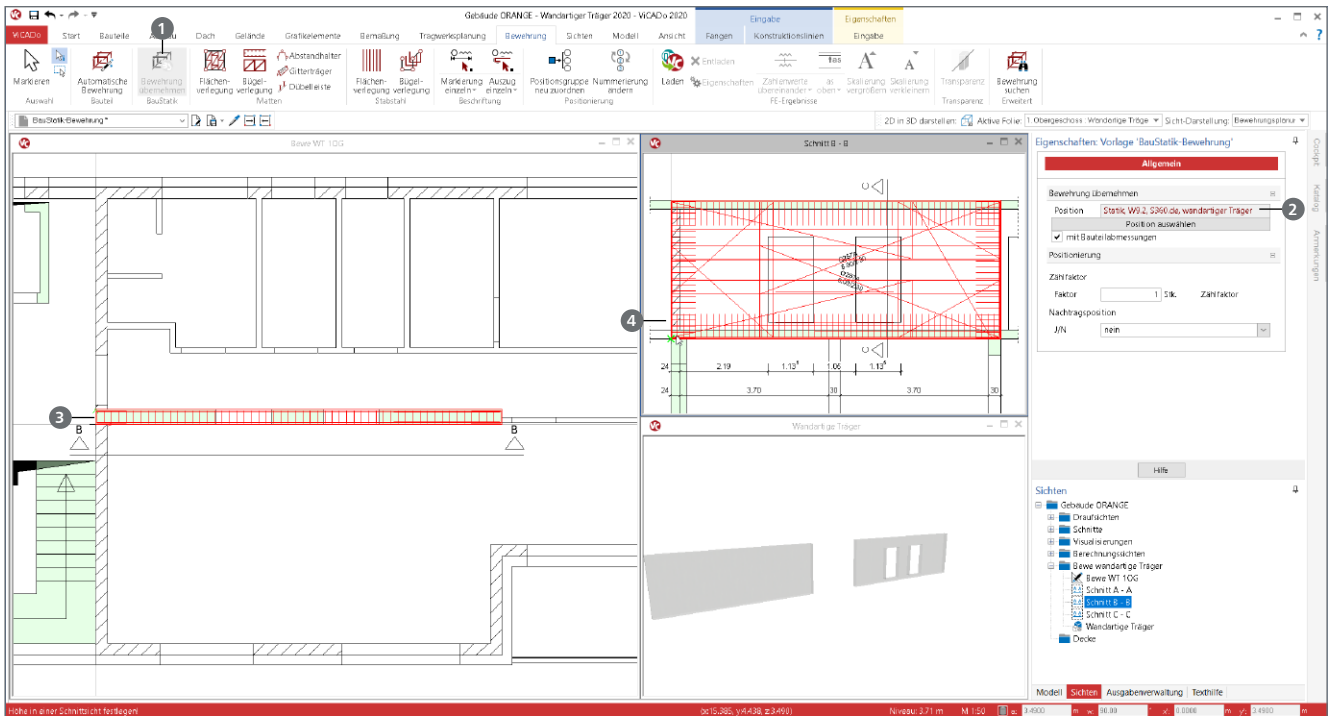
Übernahme und Platzierung der Bewehrung aus dem BauStatik-Modul „S360.de“
